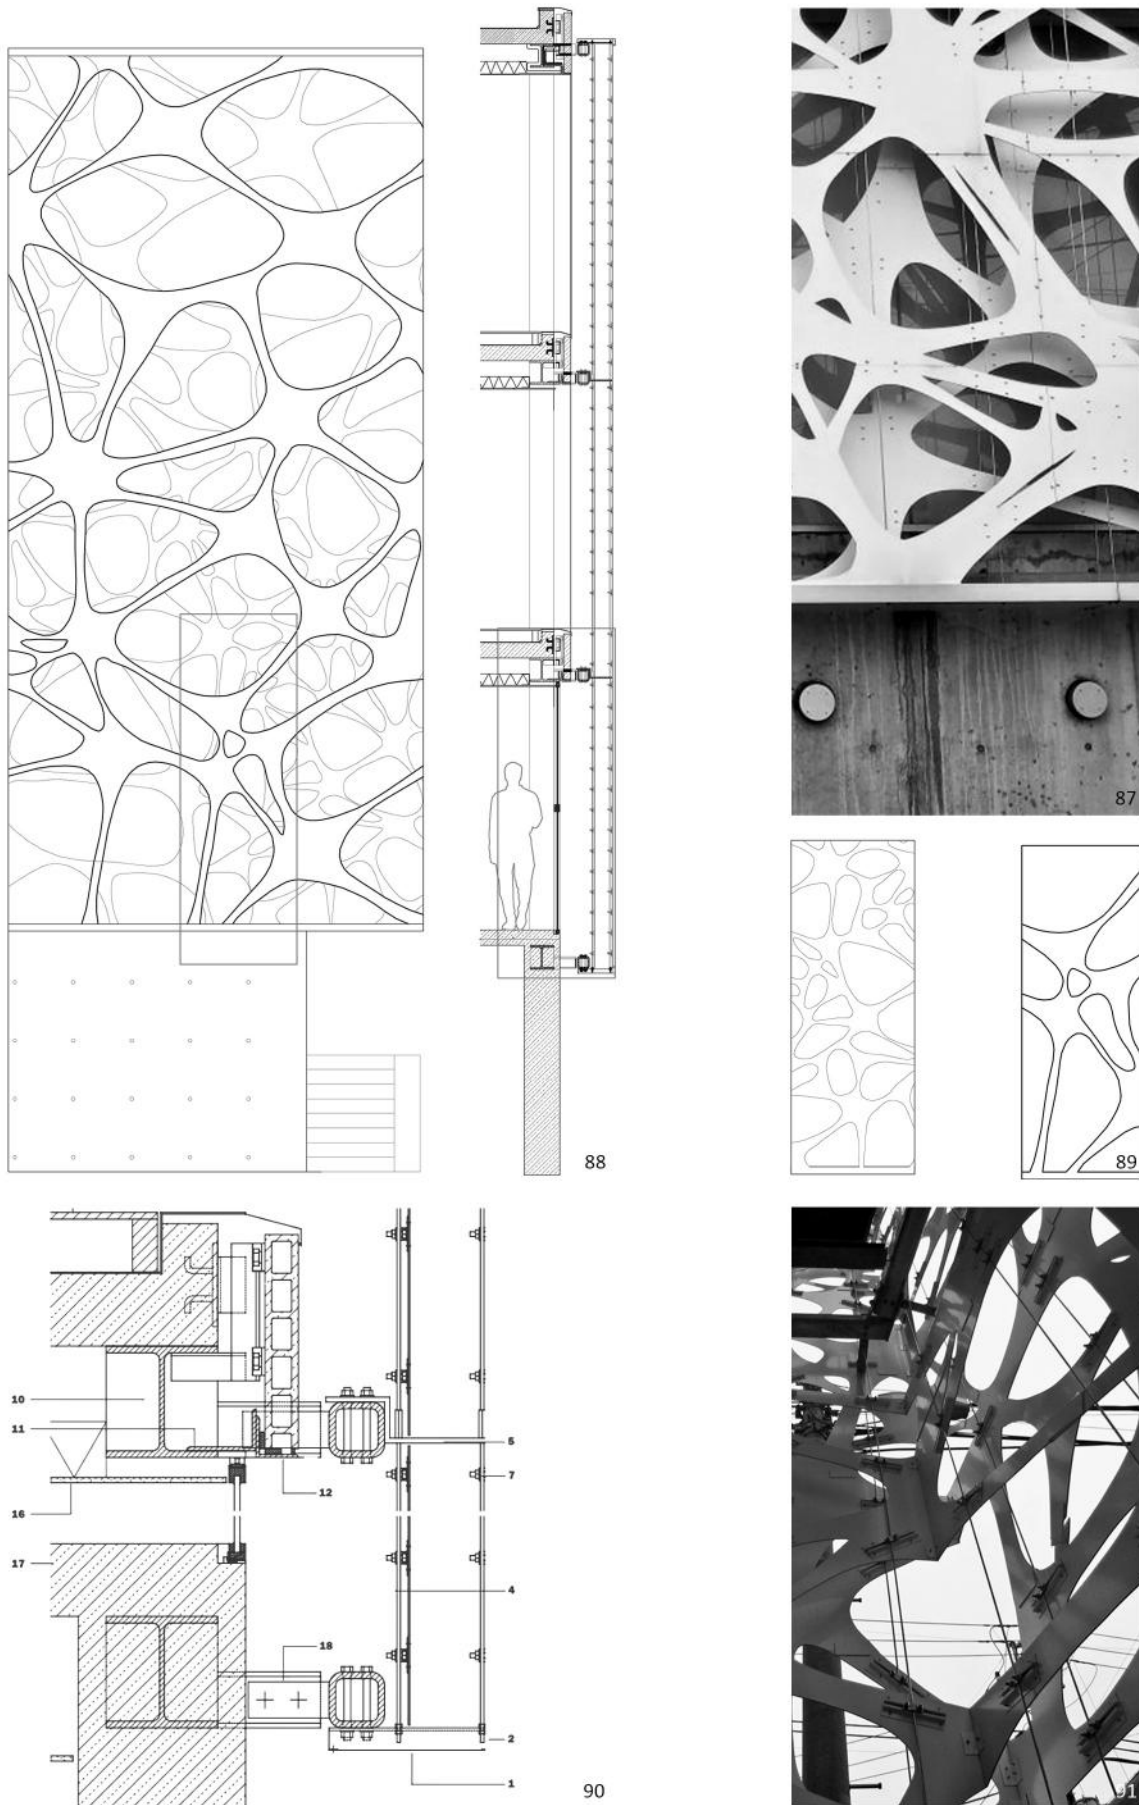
, 89. Alzado, sección y esquema de las dos pieles superpuestas de fachada.
